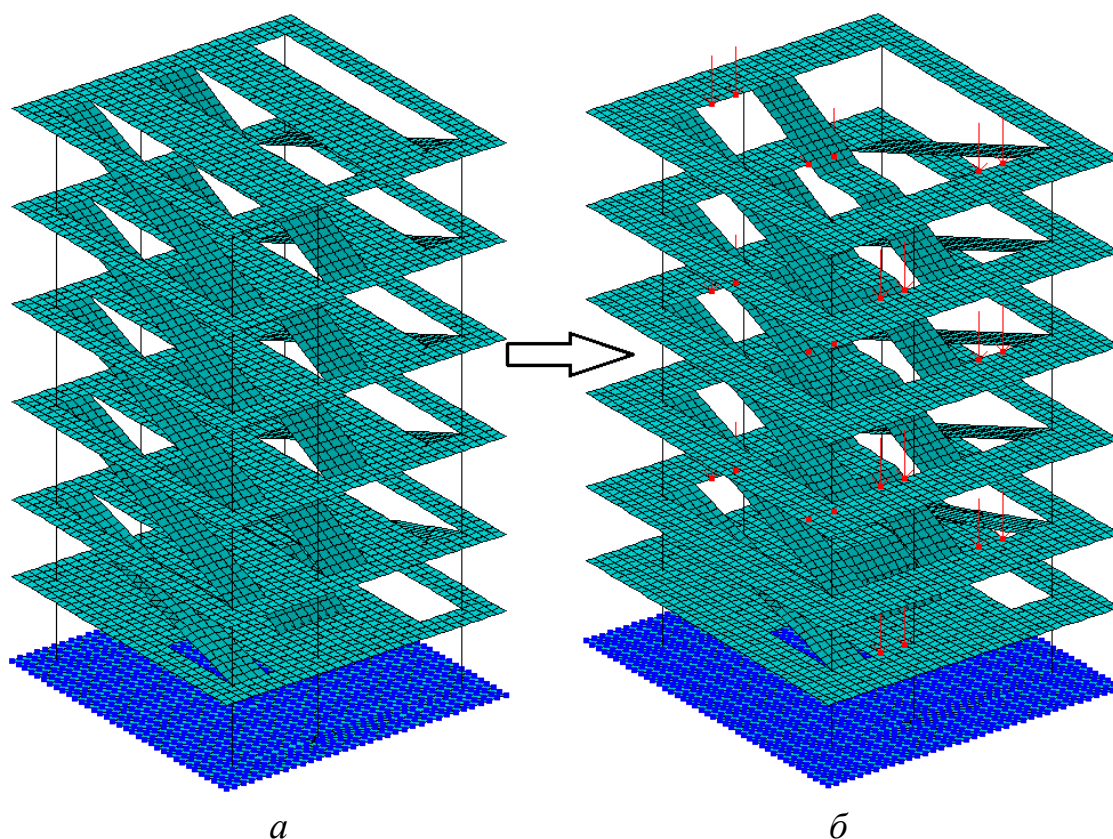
Фрагмент розрахункової схеми торгово-розважального комплексу, *a* – при наявності плит перекриття; *б* – з демонтованими плитами перекриття
